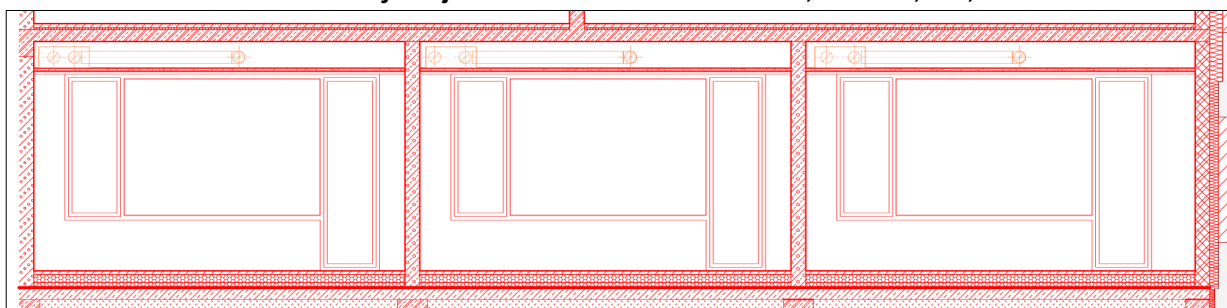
/ Půdorys objektu ZŠ a MŠ Antonínská – 1NP, m.č. 060
